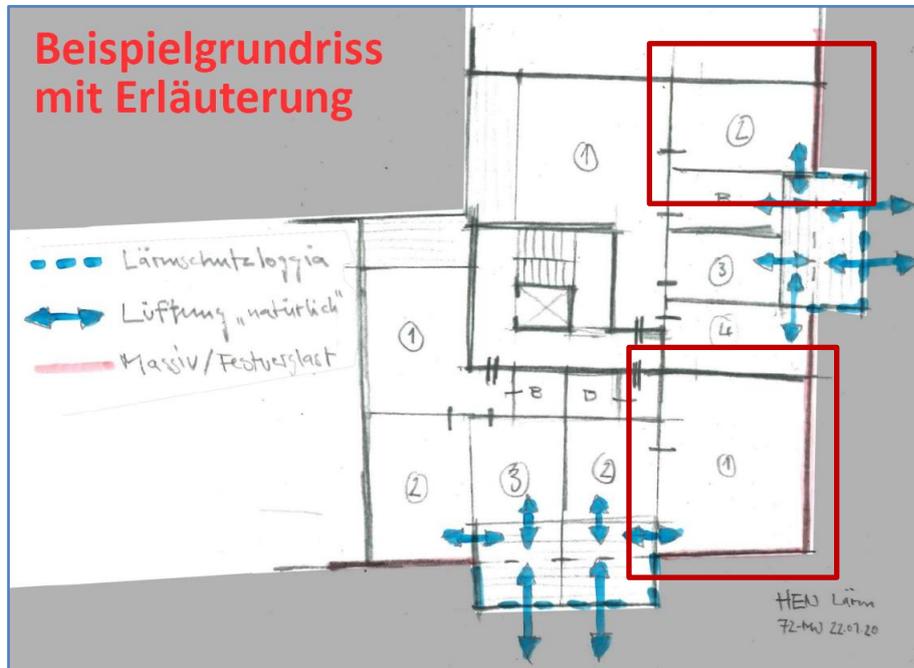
Beispielgrundriss für den südwestlichen Gebäudebereich im Baufeld C
